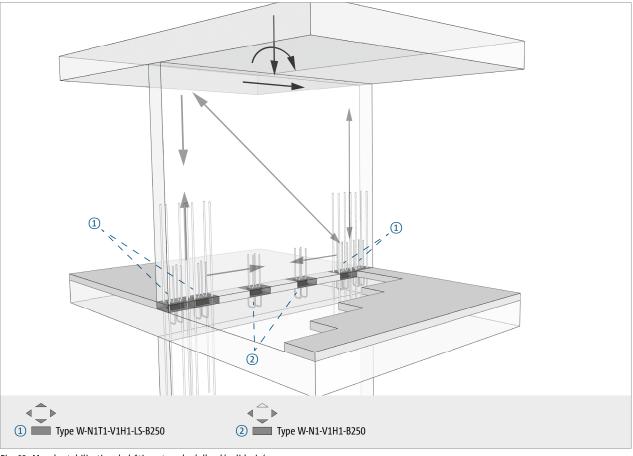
Mur de stabilisation du bâtiment sur la dalle, désolidarisé
